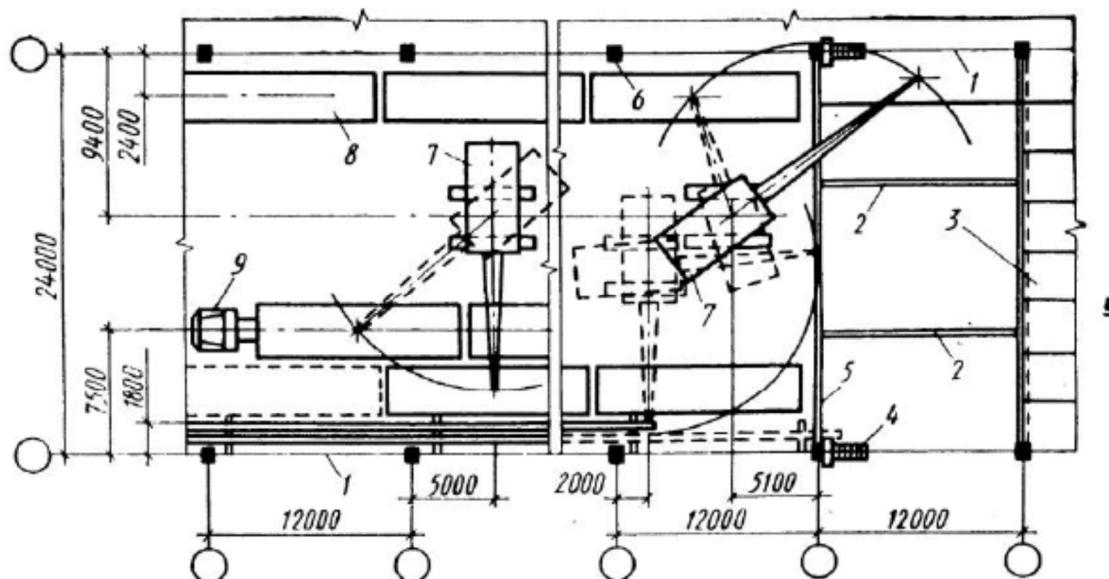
Схема выгрузки, раскладки элементов и монтажа покрытия в пролетах 24 м, с шагом колонн и ферм 12 м продольным методом: 1 - временное ограждение; 2 - инвентарная распорка для временного крепления ферм; 3 - смонтированное покрытие 4 - лестница-площадка приставная; 5 - стропильная ферма; 6- колонна; 7 - кран; 8 - штабель плит; 9 - транспортное средство.
